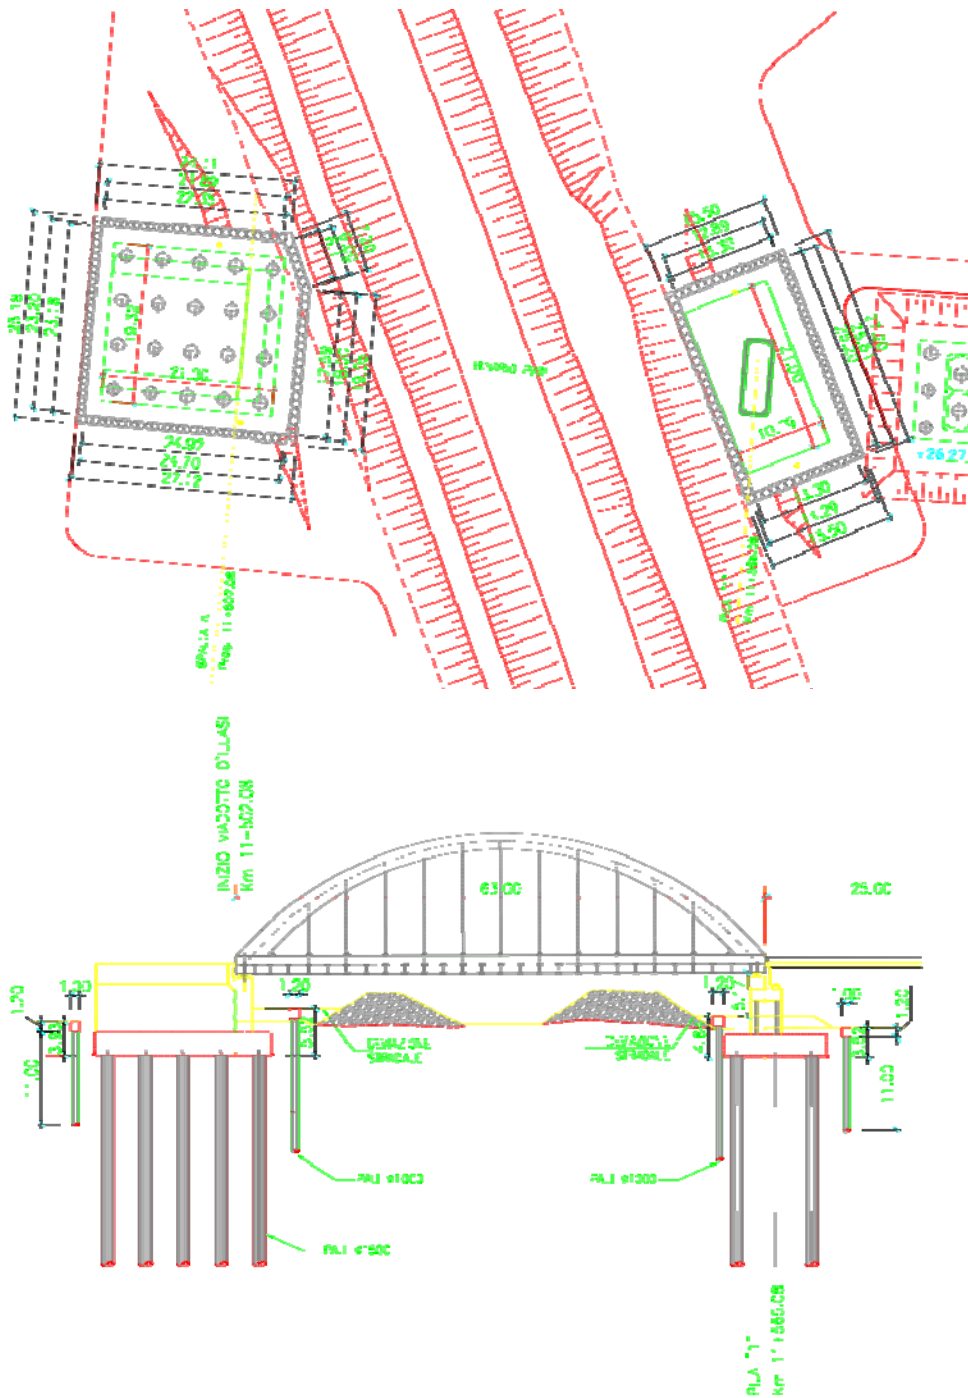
Geometria scavo Spalla Ovest e Pila n.1
